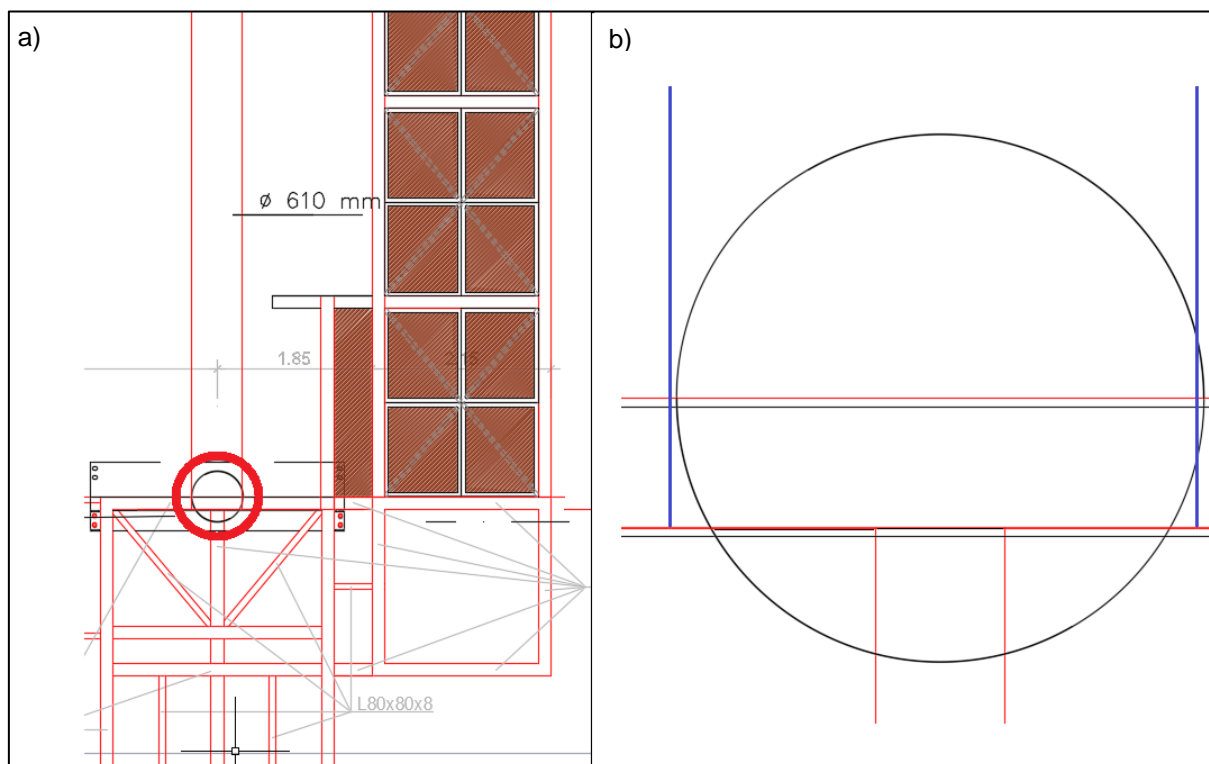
a) Alçado e planta em *AutoCAD*®; b) Pormenor: alçado a azul e planta a vermelho e preto
